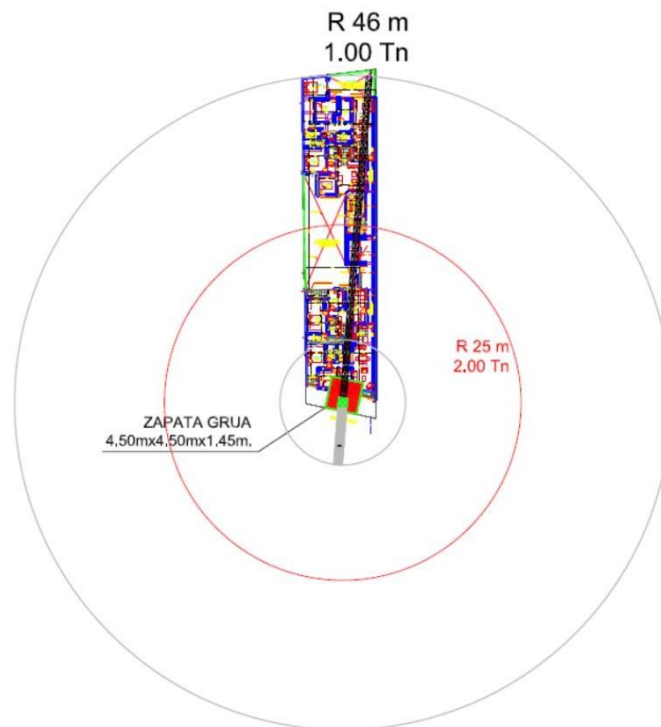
Vista en planta del recorrido del brazo de la grúa.
